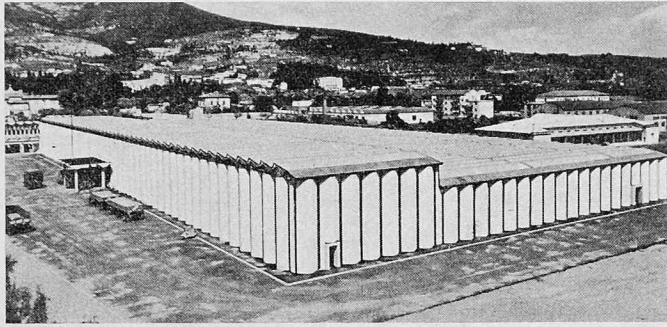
Tragende, vorgespannte Falterkswände; ihre Querscheibe ist zugleich der Kranbalken
